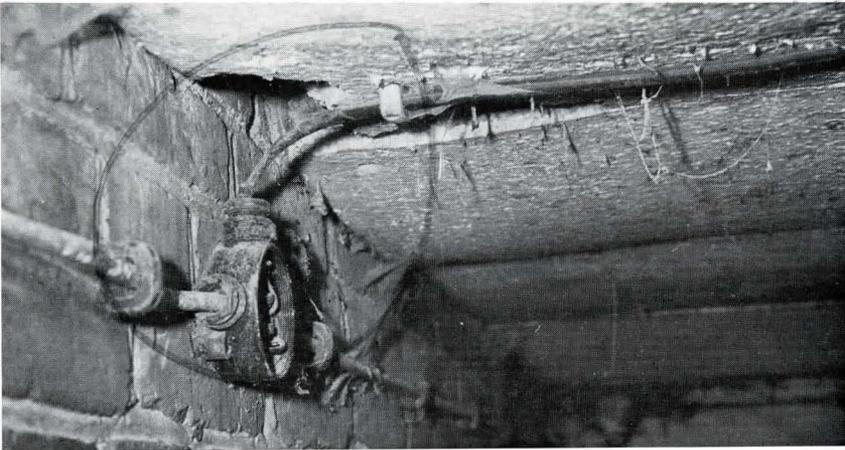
Nagetierfraß an kunststoffisolierten Leitungen.
